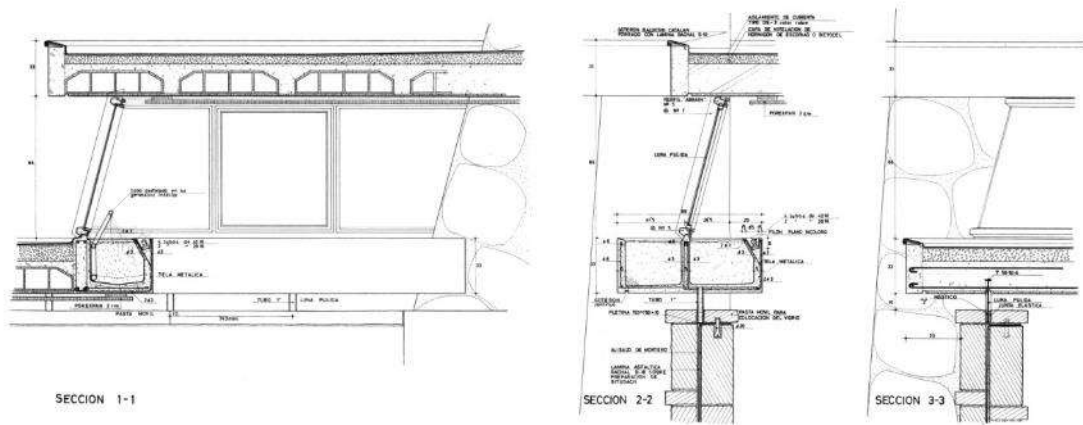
Casa Vázquez. Detalles constructivos. Plano 4. Delineado en 1963. (Archivo X.B.B: Proyecto nº 57).
